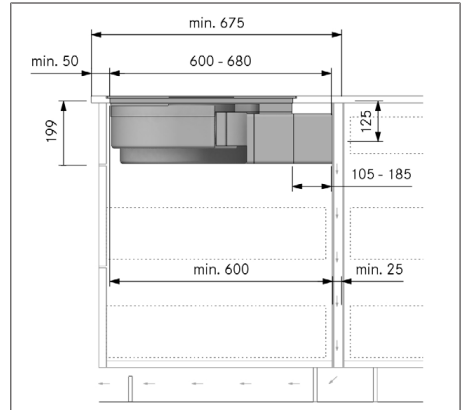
Monteringsdimensjoner ved resirkulering - monteringsvariant A, benkeplatedybde fra 675 mm
